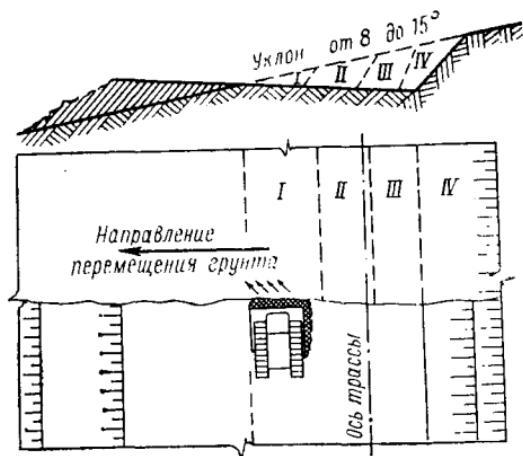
Схема разработки полки на косогоре бульдозером вертикальными слоями вдоль оси трассы
